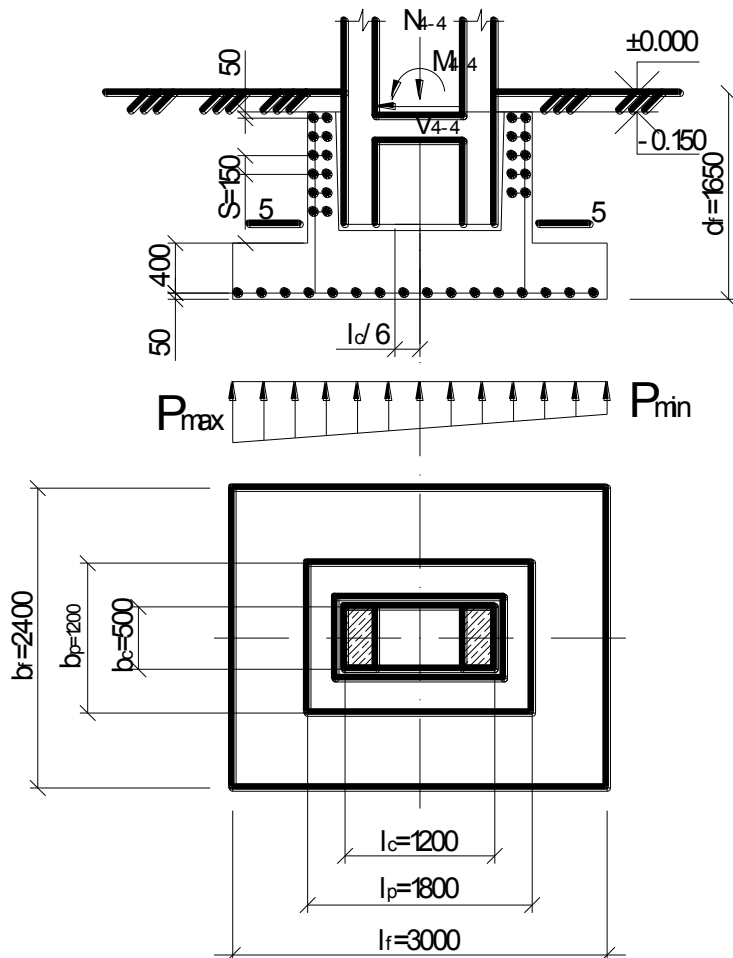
Армирование подколонника столбчатого плитного фундамента
